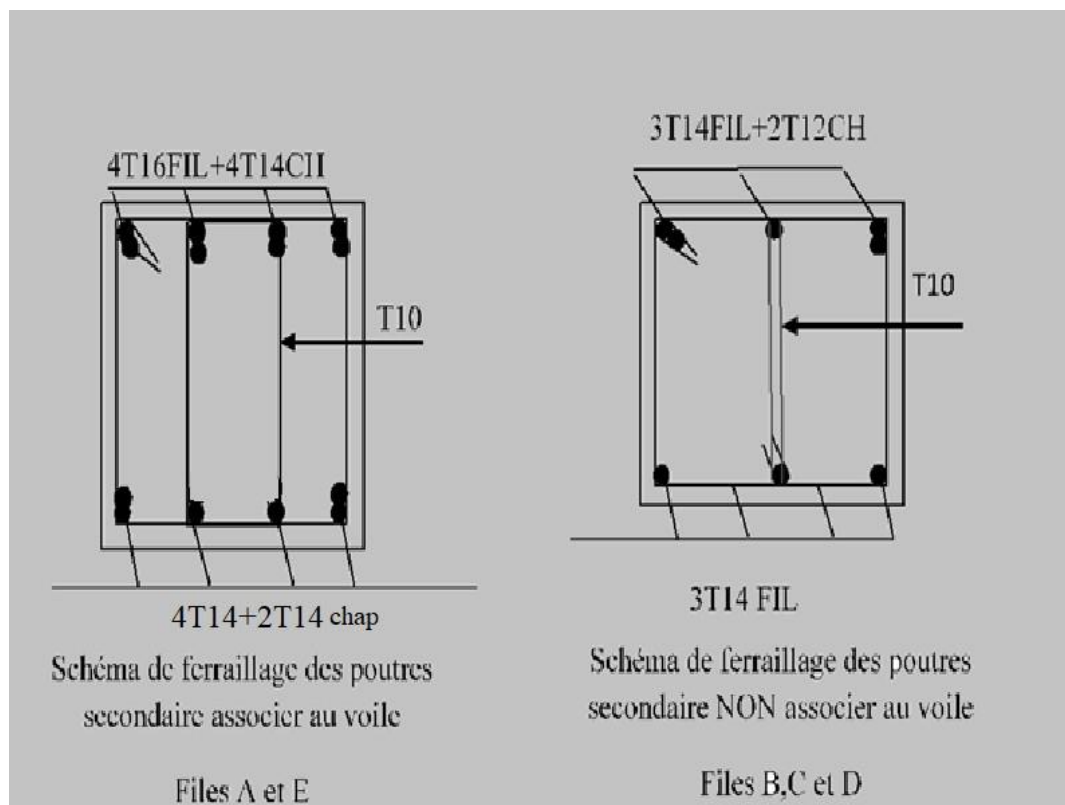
Schéma de ferrailage des Poutres secondaire
